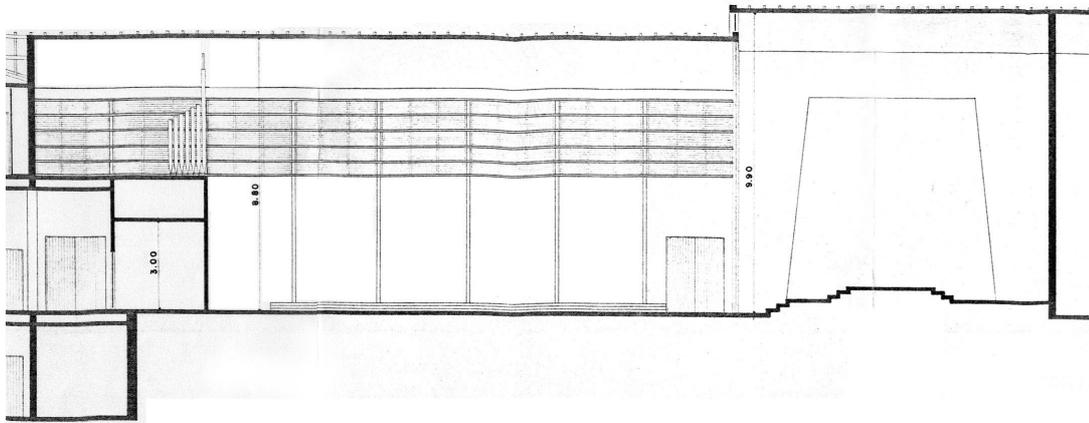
Corte longitudinal na Igreja do Coro. Segunda versão de projeto. (Fonte: Arquivo MNSG).
